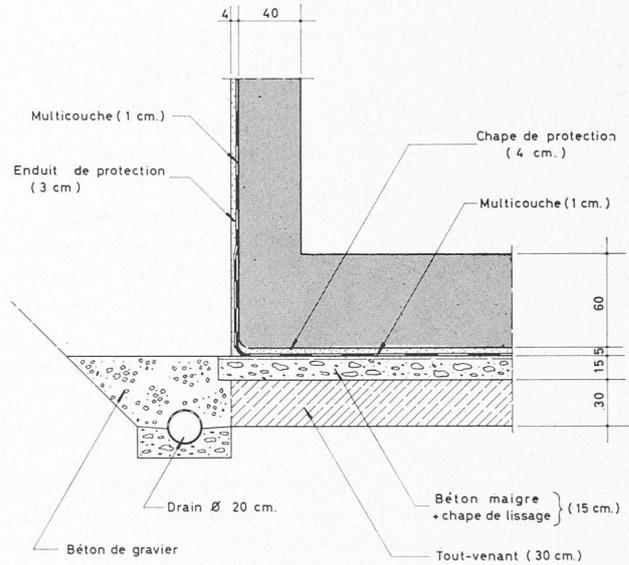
Coupe détaillée du sous-radier et du radier.
